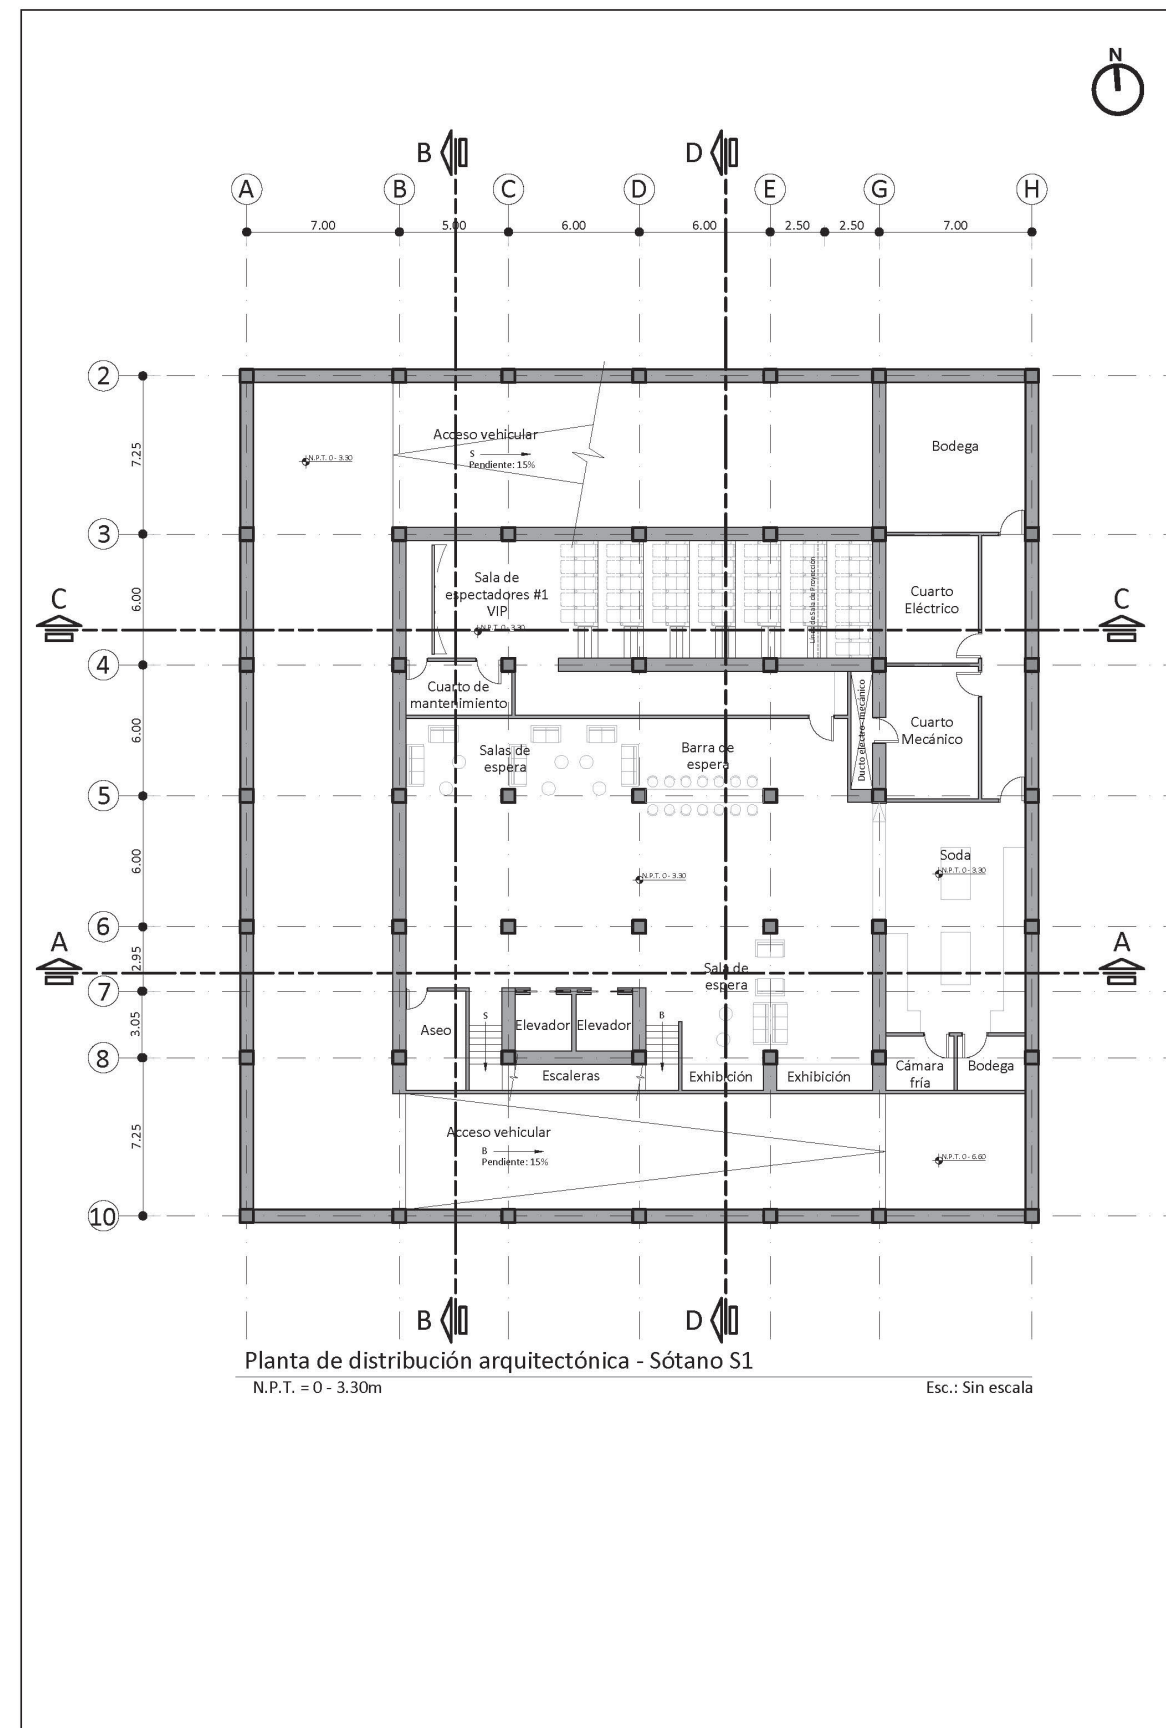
Planta de distribución arquitectónica de sótano 1. Fuente: Propia.
